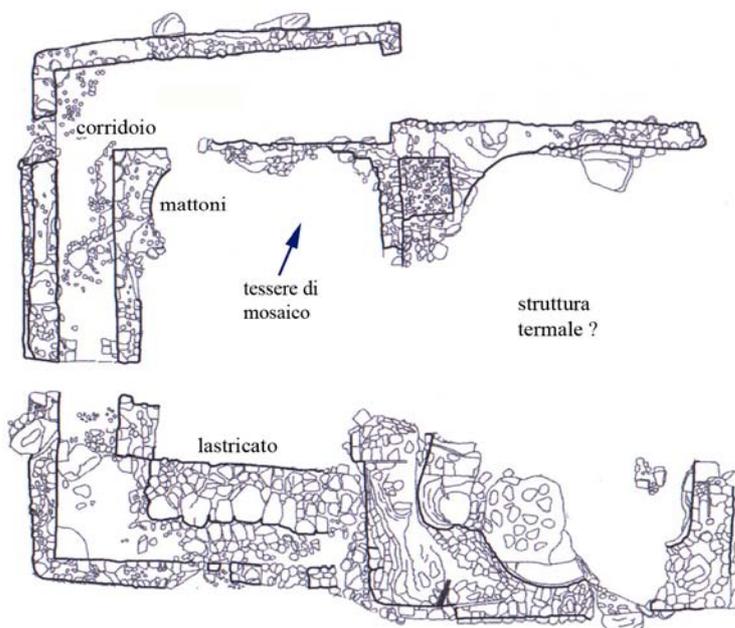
Planimetria dell'edificio nella fase Romano imperiale
